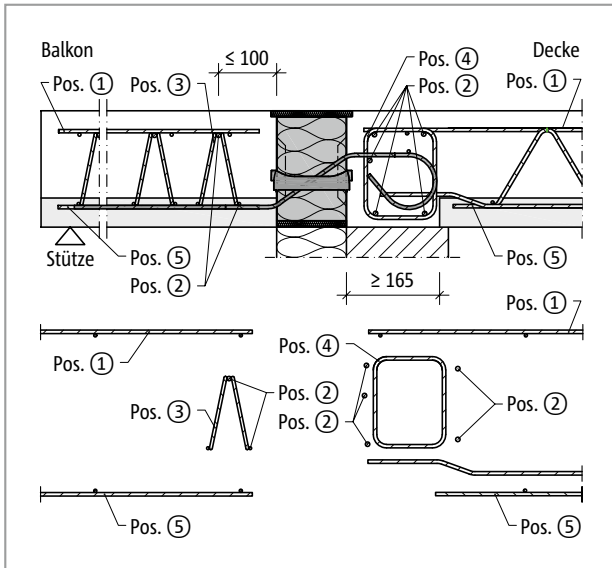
Schöck Isokorb® XT Typ Q-V1 bis V4 Bauseitige Bewehrung mit Gitterträger
